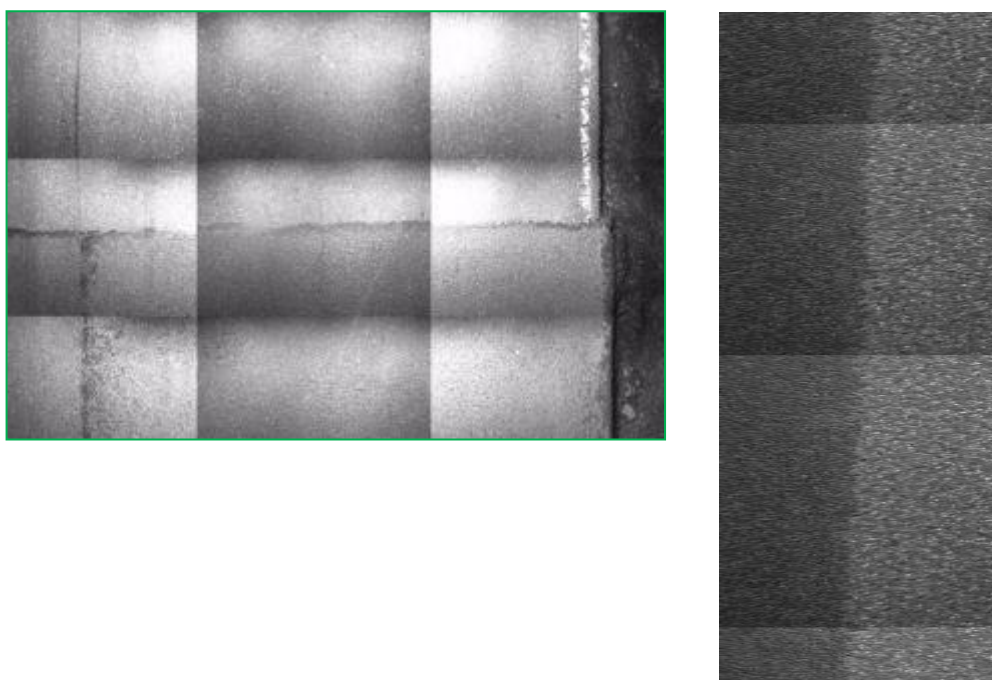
Spojenia technologiczne wzdłuż kierunku jazdy widziane na zdjęciu pasa ruchu (fragment)
